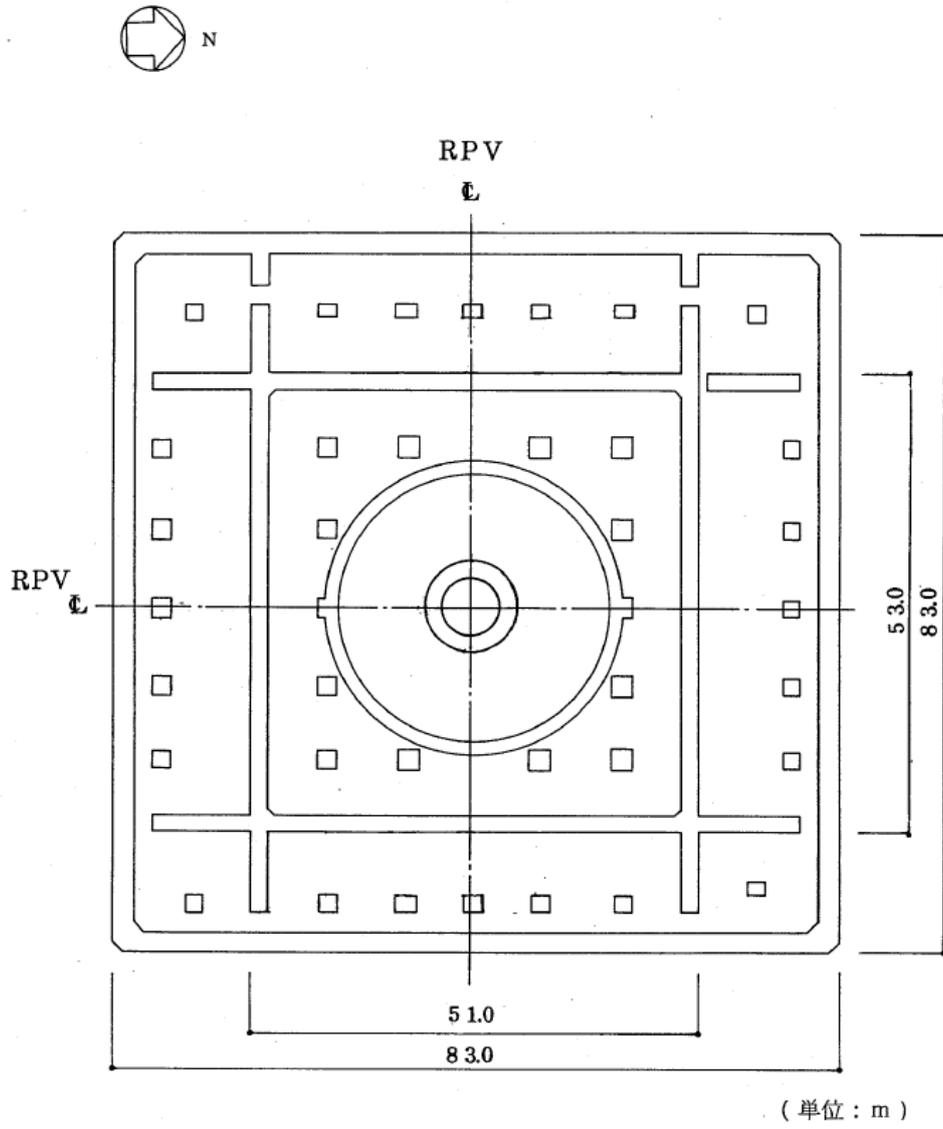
5号炉原子炉建屋概略平面图 (基础盘上)
